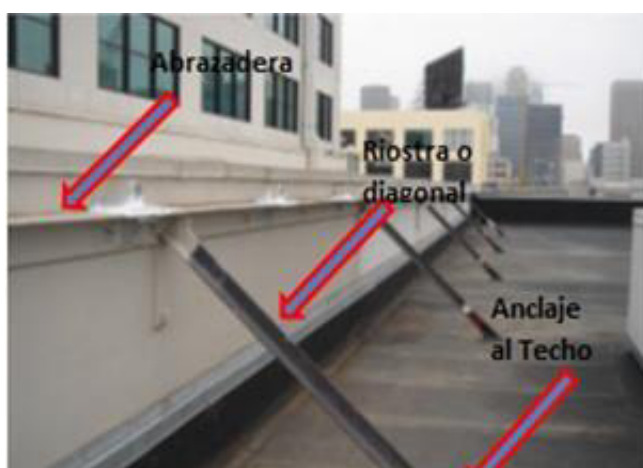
Foto Ejemplo FEMA E74 (6.3.5.1-4)
